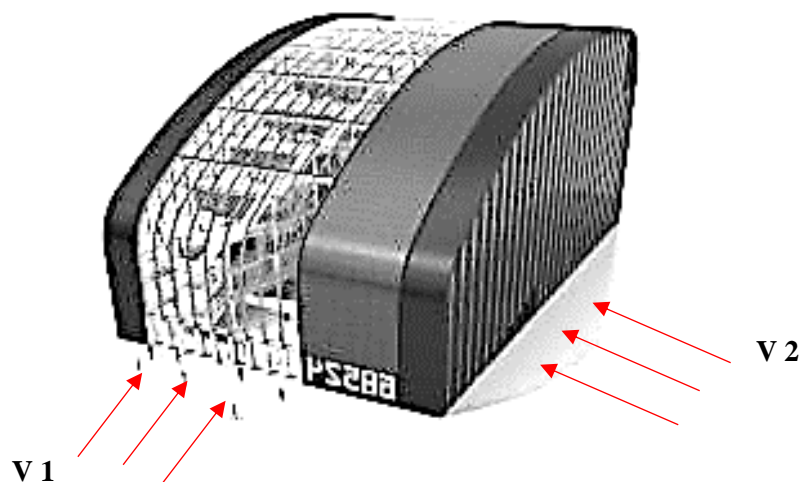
direction de la pression dû au vent agissant sur le bâtiment.
